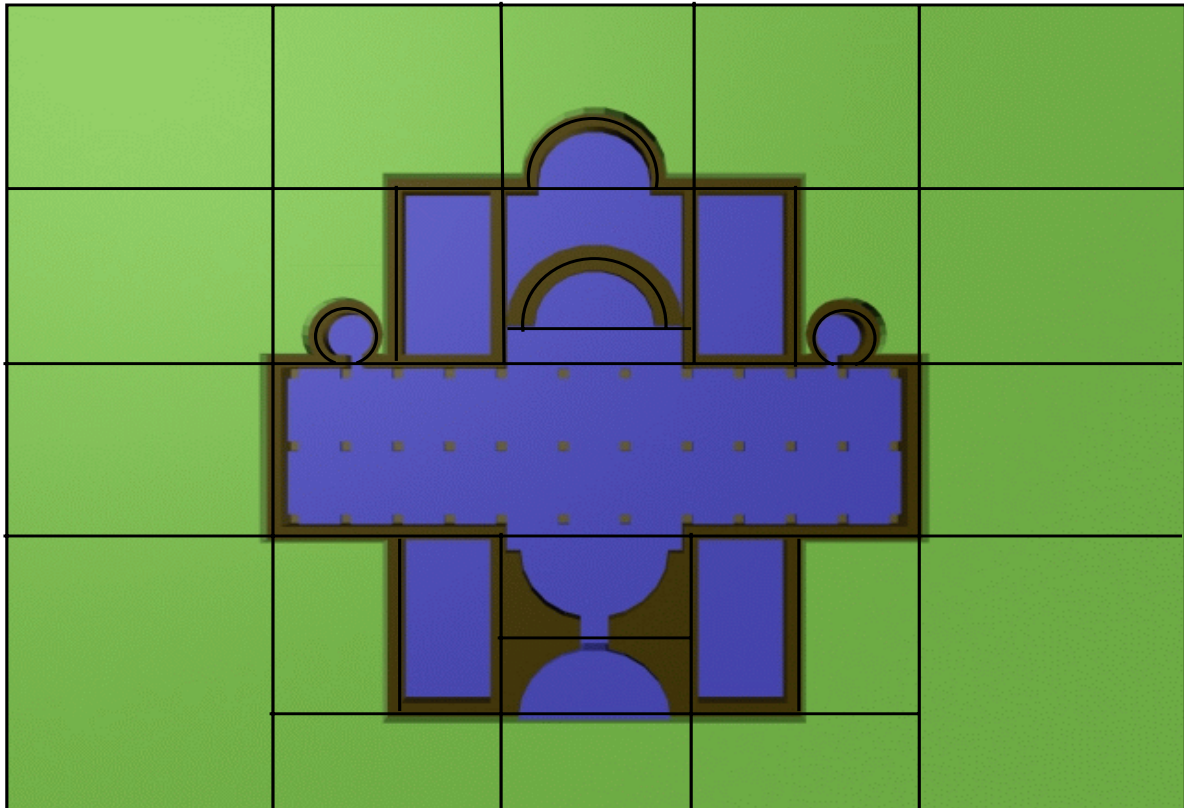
Gebäudegrundriss mit Rechtecksraster (KÖNIG 1999, 60)
